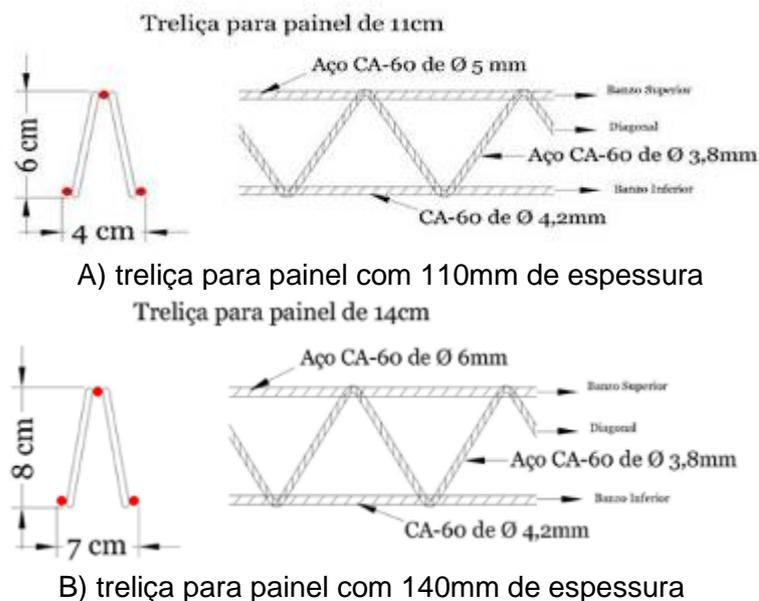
Especificação das treliças metálicas utilizadas nos painéis
